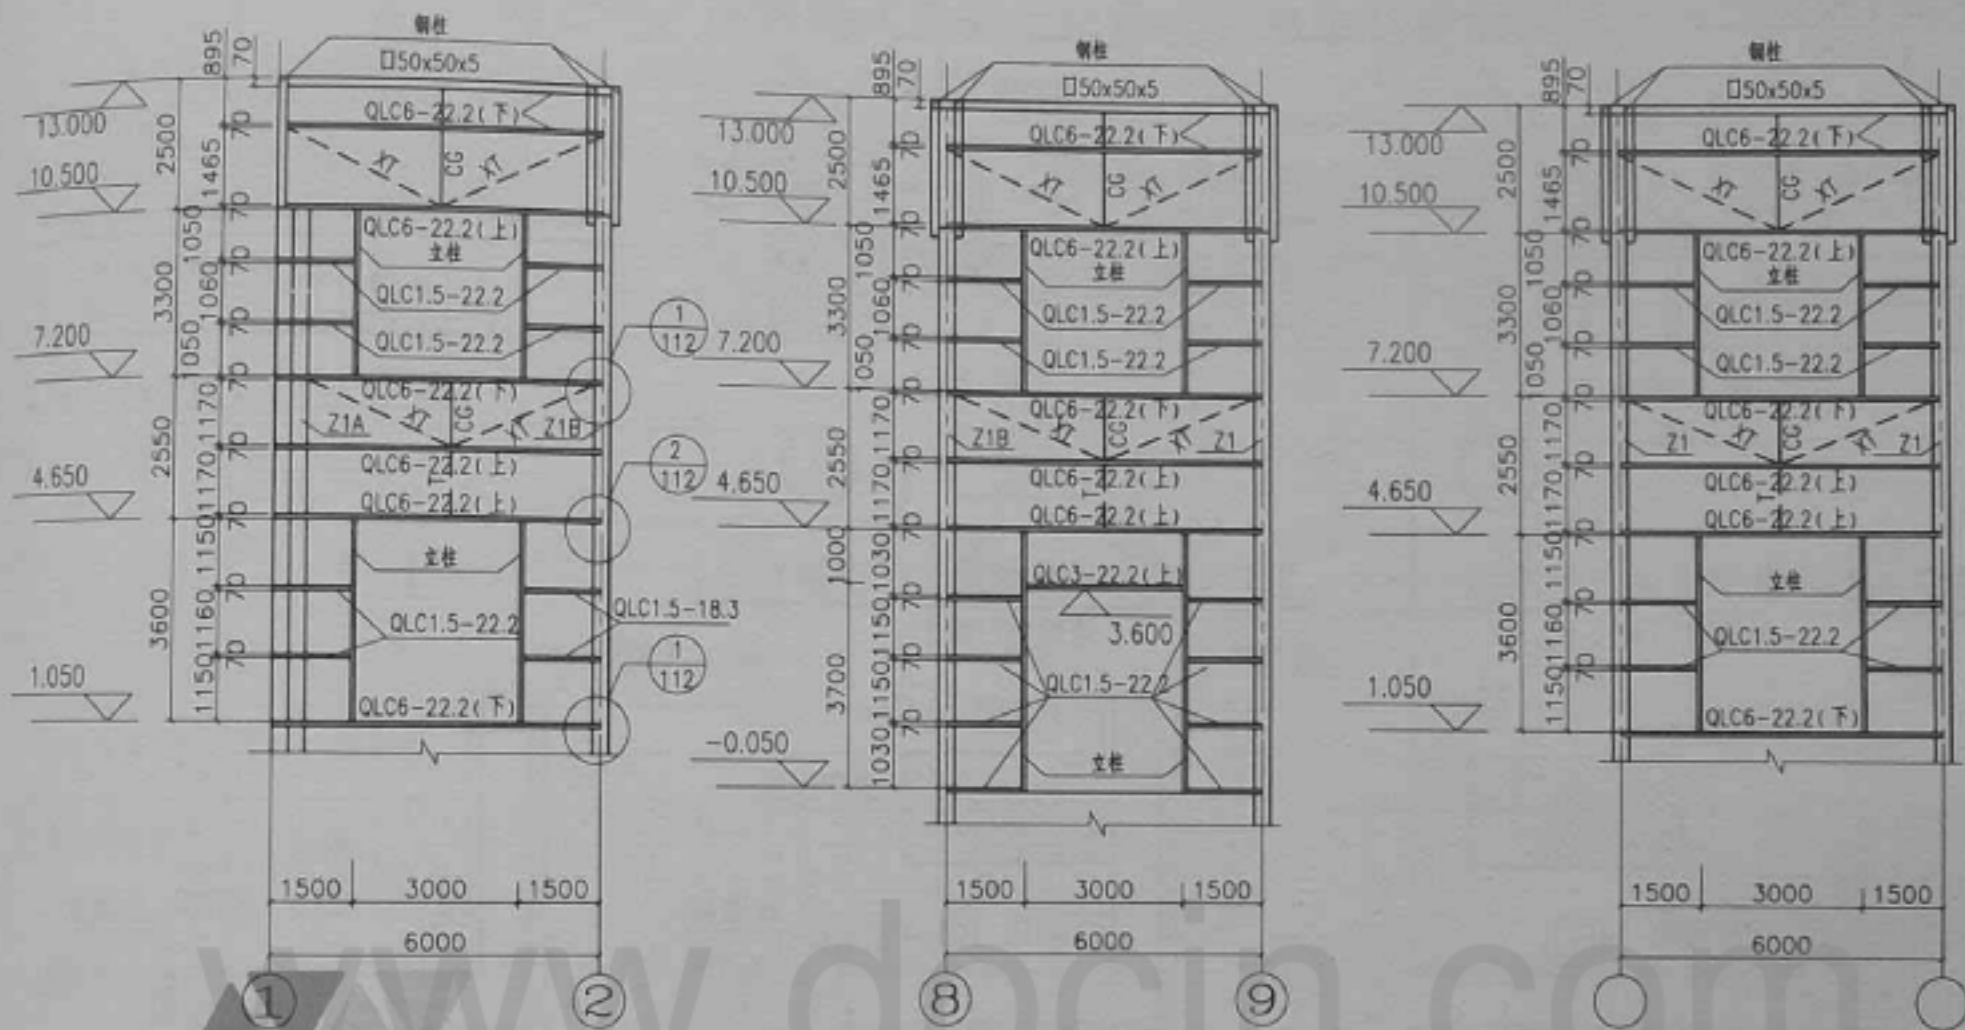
外纵墙端开间墙梁布置图 图2-19 外纵墙设外门开间墙梁布置图 图2-20 外纵墙中部开间墙梁布置图
